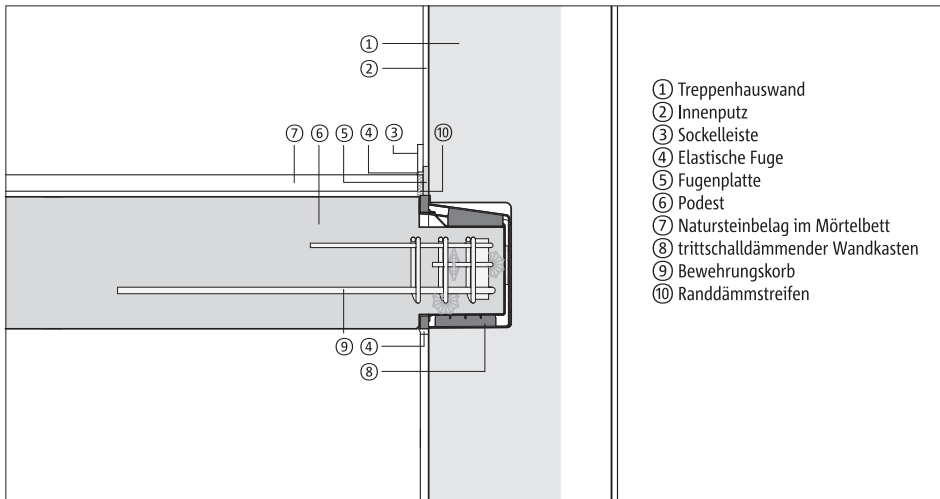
Beispielhaftes Anschlussdetail – Podest an Treppenhauswand mit vorgefertigtem Bewehrungskorb (Tragelement)
